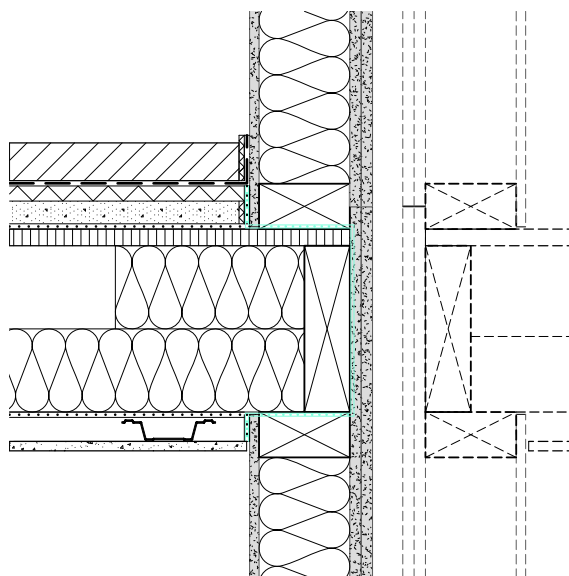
Anschluss Geschosdecke an Gebäudetrennwand.
